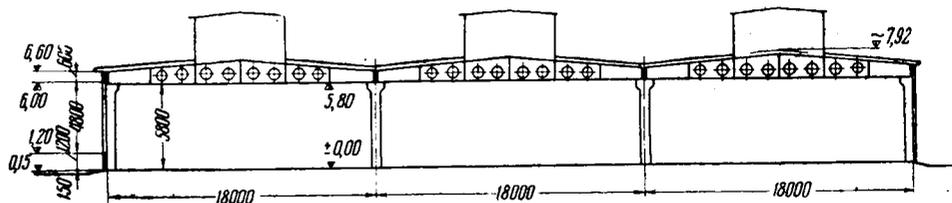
Здание деревообрабатывающего цеха из сборного железобетона с пролетом 54 м (разрез)
